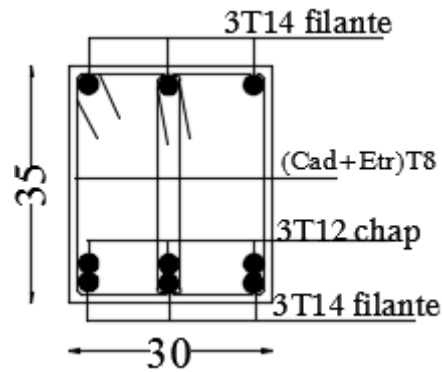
Ferrailage en travée d'une poutre secondaire.
